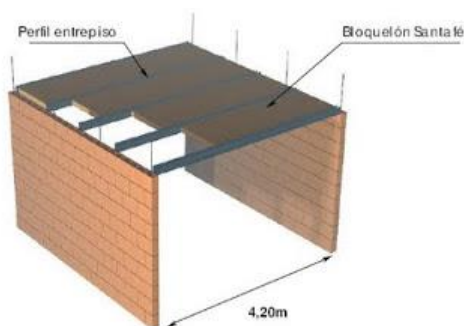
Instalación de perfiles y bloquelones sistema placa fácil
